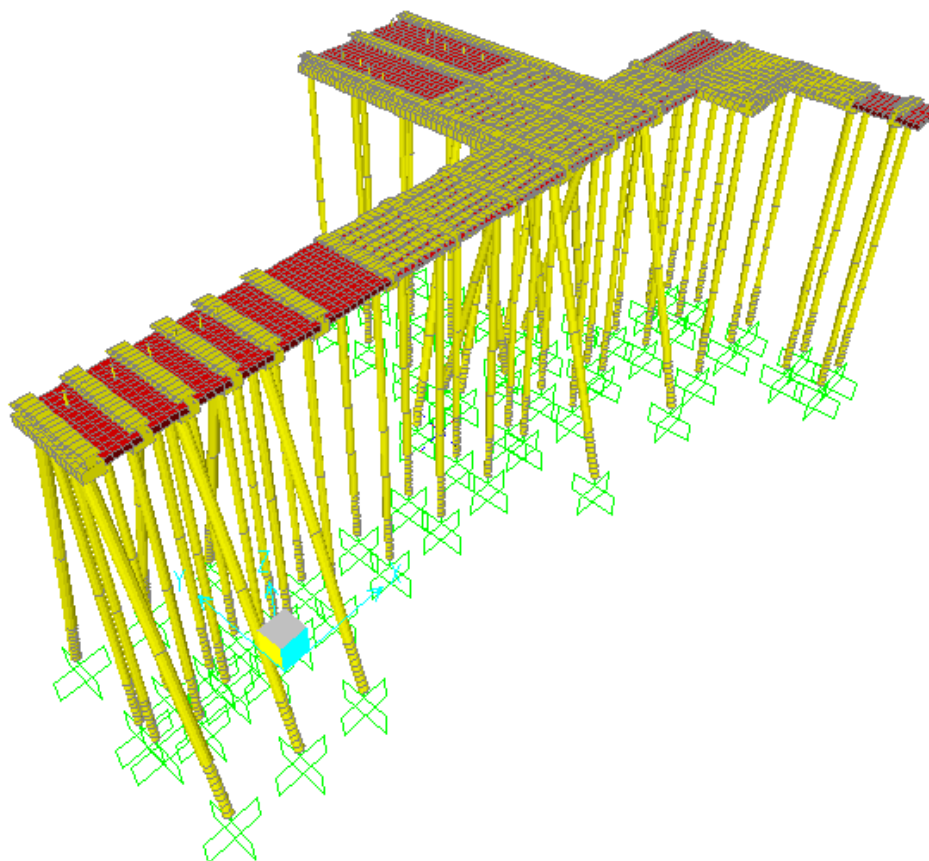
Vista Isométrica do Modelo Estrutural – Projeto Alternativo (PA)
